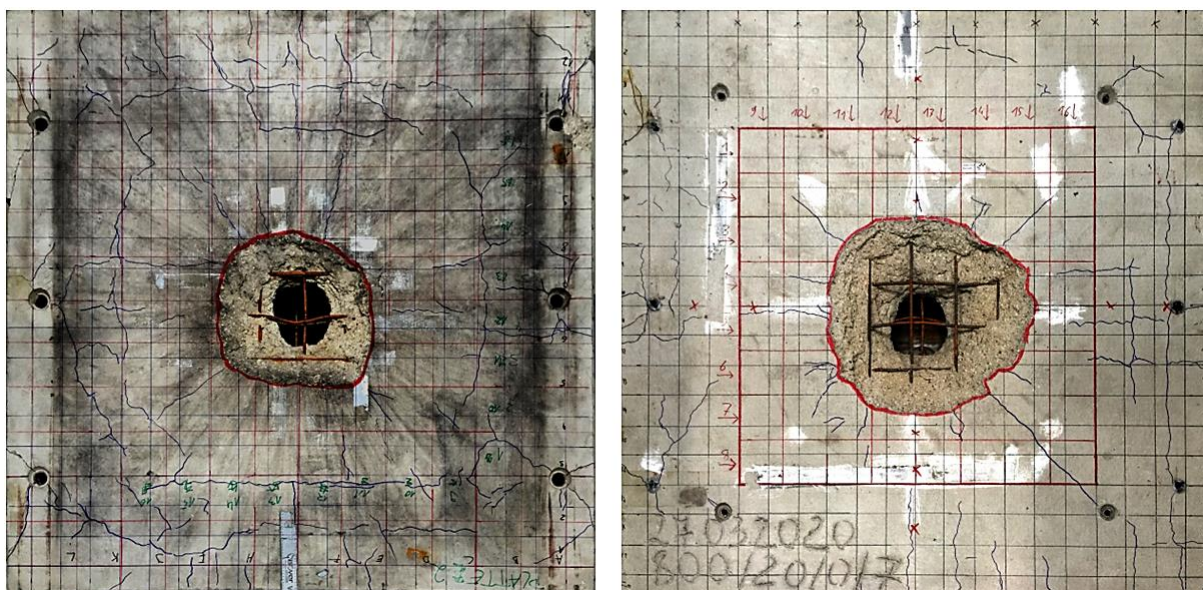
Gerissene Plattenoberflächen nach Kontaktdetonation (S-20-0-3).
